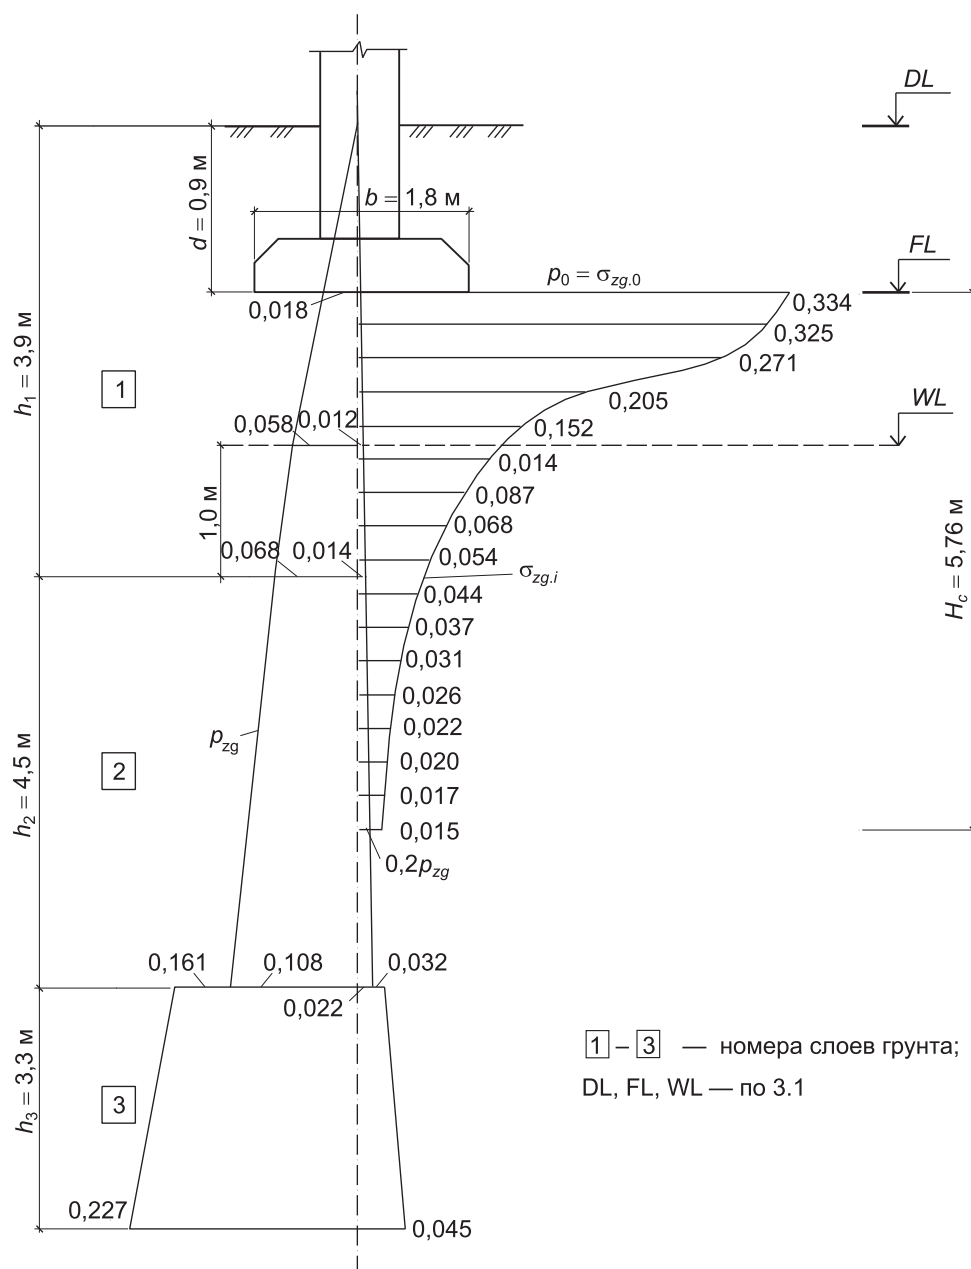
Расчетная схема основания фундамента к примеру Г.7
